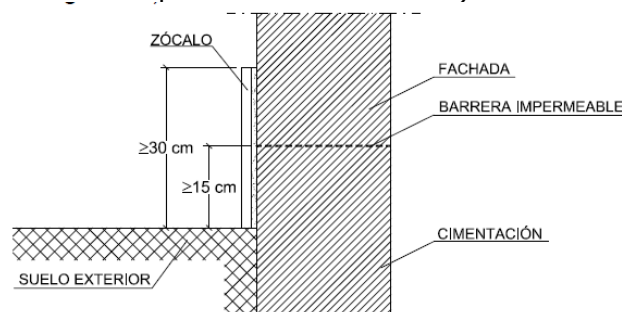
Ejemplo de arranque de la fachada desde la cimentación
